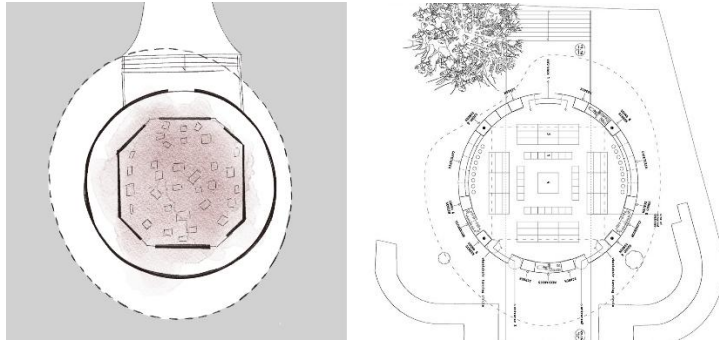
y 34: Planta diagramática y planta técnica, Fuente: Elaboración Propia y (Metalocus.es, 2018)
